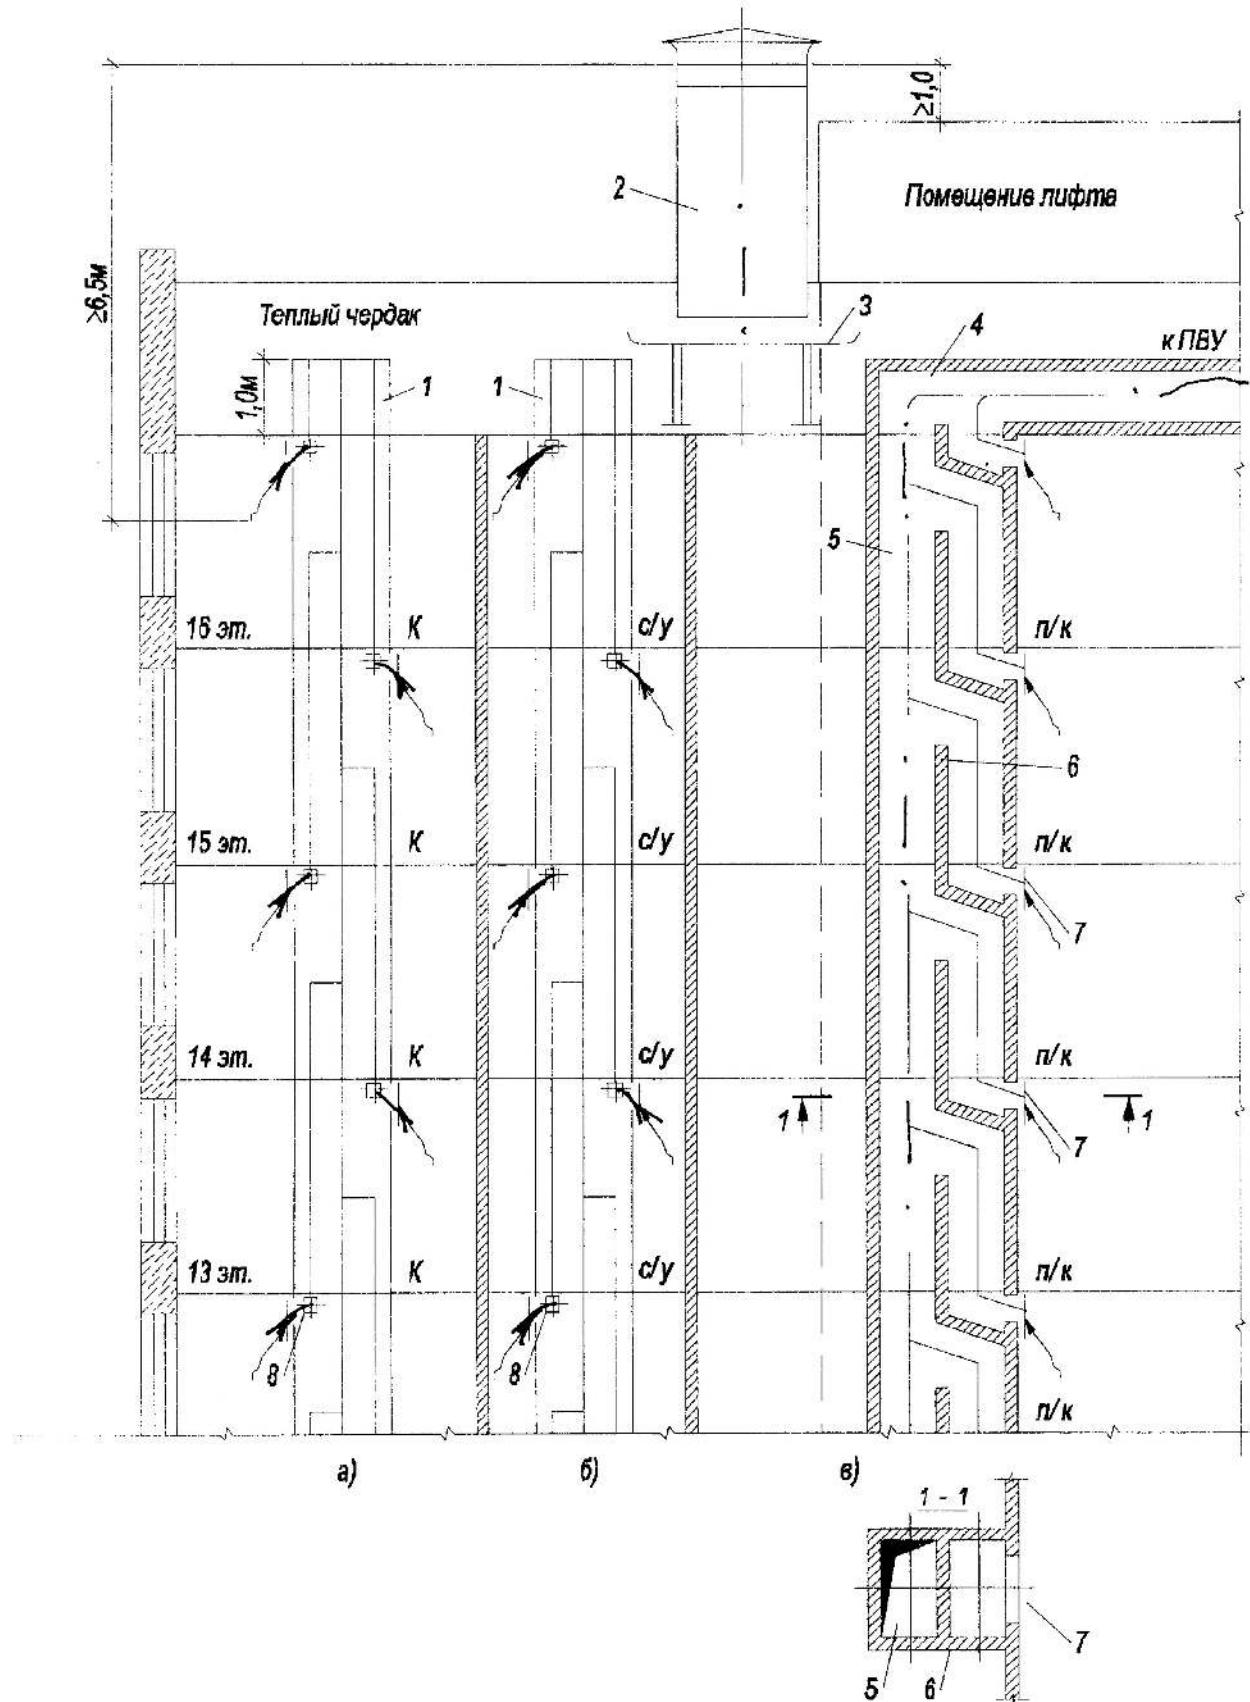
Вентиляция жилого здания с теплым чердаком (а – каналы-спутники кухонь; б – каналы-спутники санузлов; в – противодымная вентиляция лестничной клетки (разрез и план); 1 – оголовники блоков каналов-спутников; 2 – вытяжная шахта естественной системы теплого чердака; 3 – поддон шахты для сбора конденсата; 4 – сборный канал механической противодымной системы; 5 – противодымная шахта; 6 – рассечка; 7 – автоматический клапан и датчик; 8 – жалюзийная решетка; к – кухни; с/у – санузлы; л/к – лестничные клетки; ПВУ – противодымная вытяжная механическая установка)
